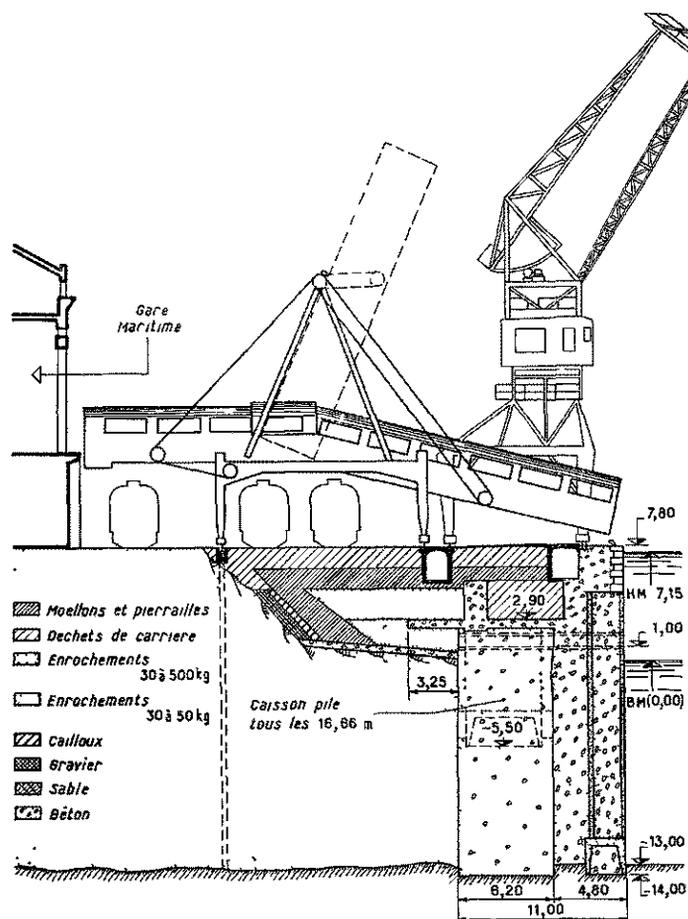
Coupe du quai reconstruit (avec outillage)
